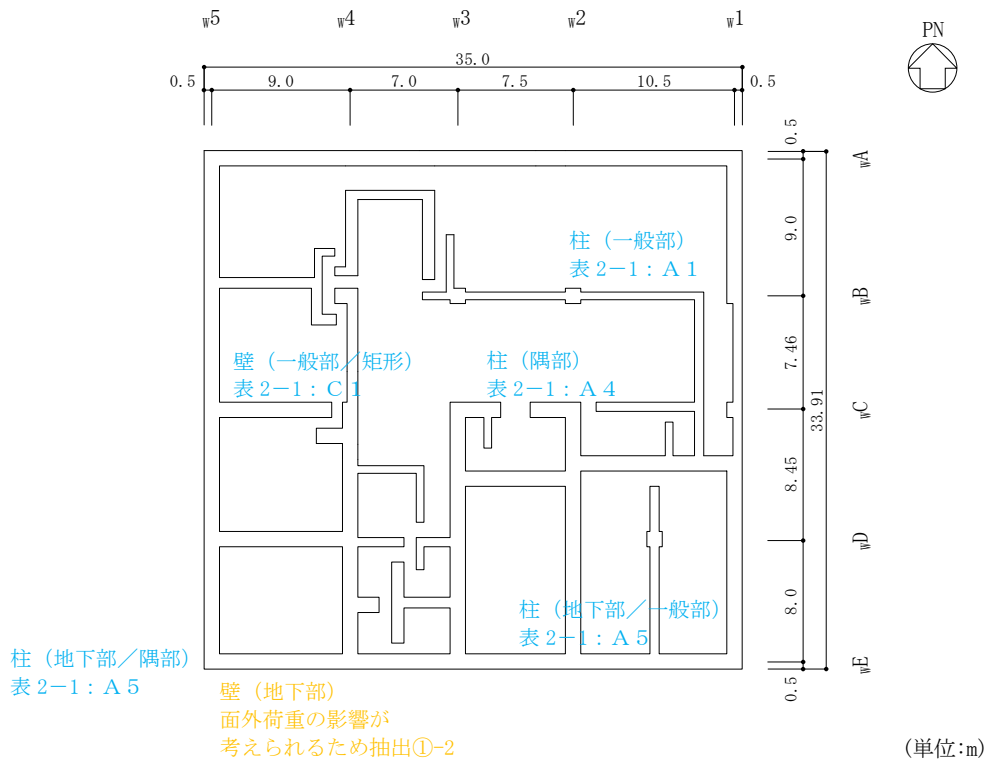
1号機廃棄物処理建物の概略平面図 (EL 6.5m)
